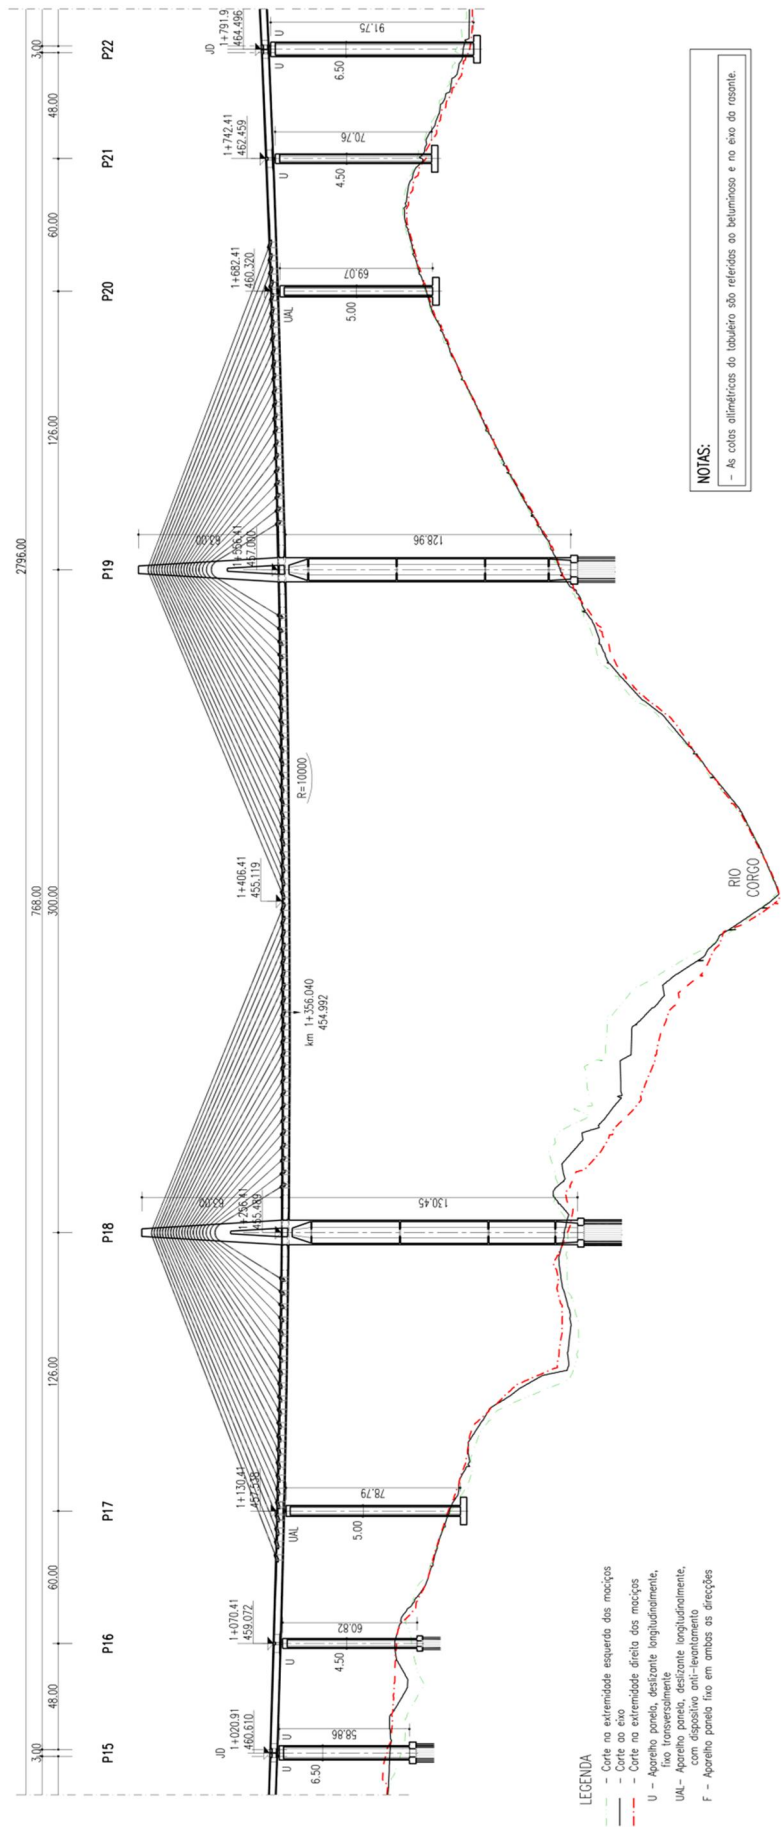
Sub-Viaduto Central do Viaduto do Corgo – Corte longitudinal pelo eixo da obra (AutoestradasXXI [et al.], 2010d)
